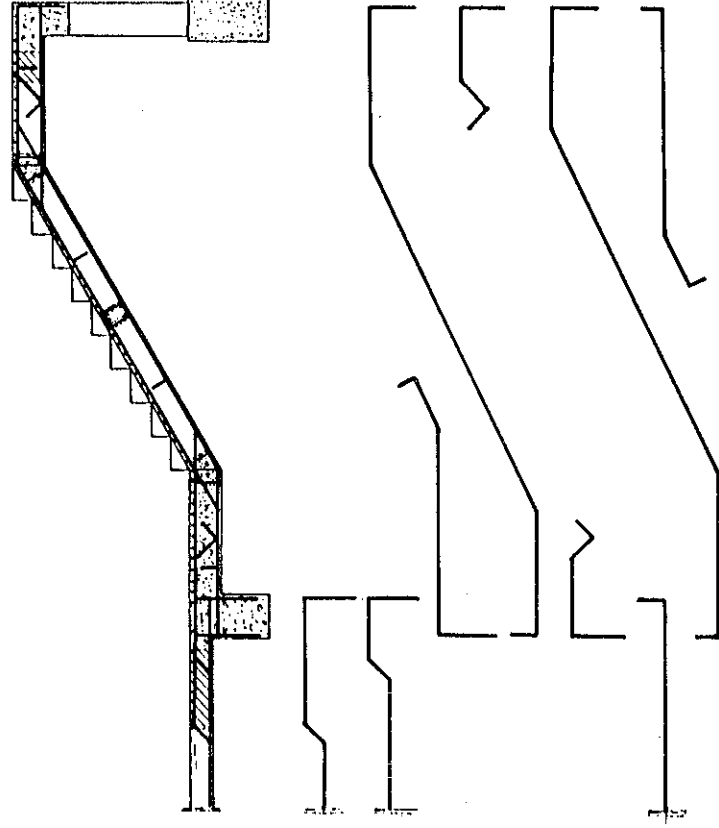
Disposizione delle armature dei travetti (rampa in salita)
